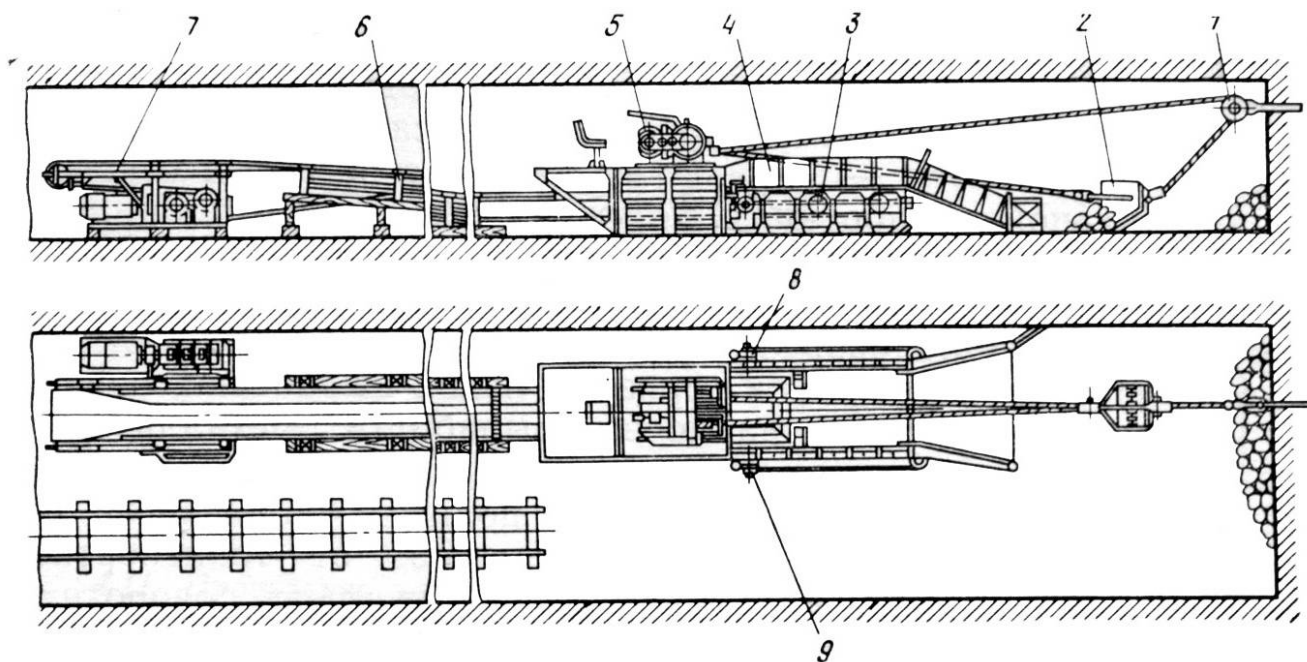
Схема скреперного комплекса МПДК-3: 1 – блок; 2 – скрепер; 3 – натяжное устройство; 4 – загрузочное устройство; 5 – скреперная лебедка; 6 – роликовые опоры; 7 – приводная головка конвейера; 8, 9 – лебедки.
